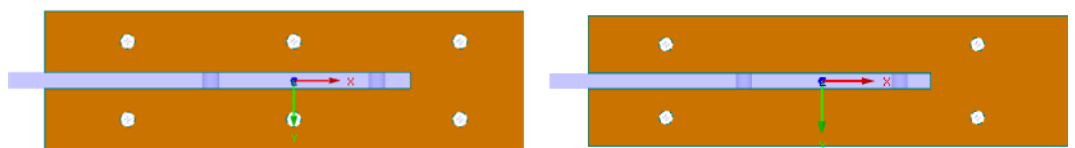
Schrauben zwischen jedem Dübel *Gleich* (links) oder nur für *Ränder* (rechts)
